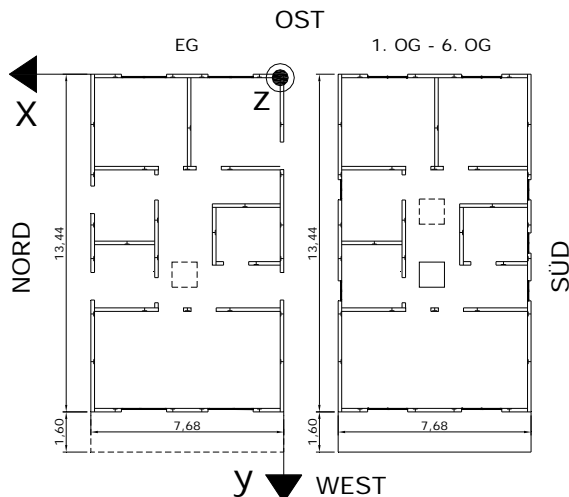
Grundrisse des siebenst6ckigen Geb6udes
